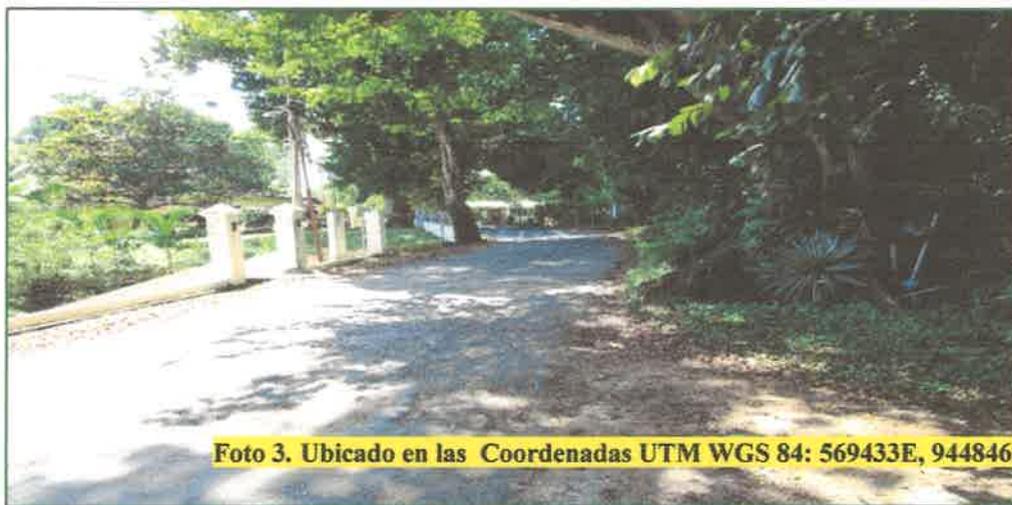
Ubicado en las Coordenadas UTM WGS 84: 569433E, 944846N
